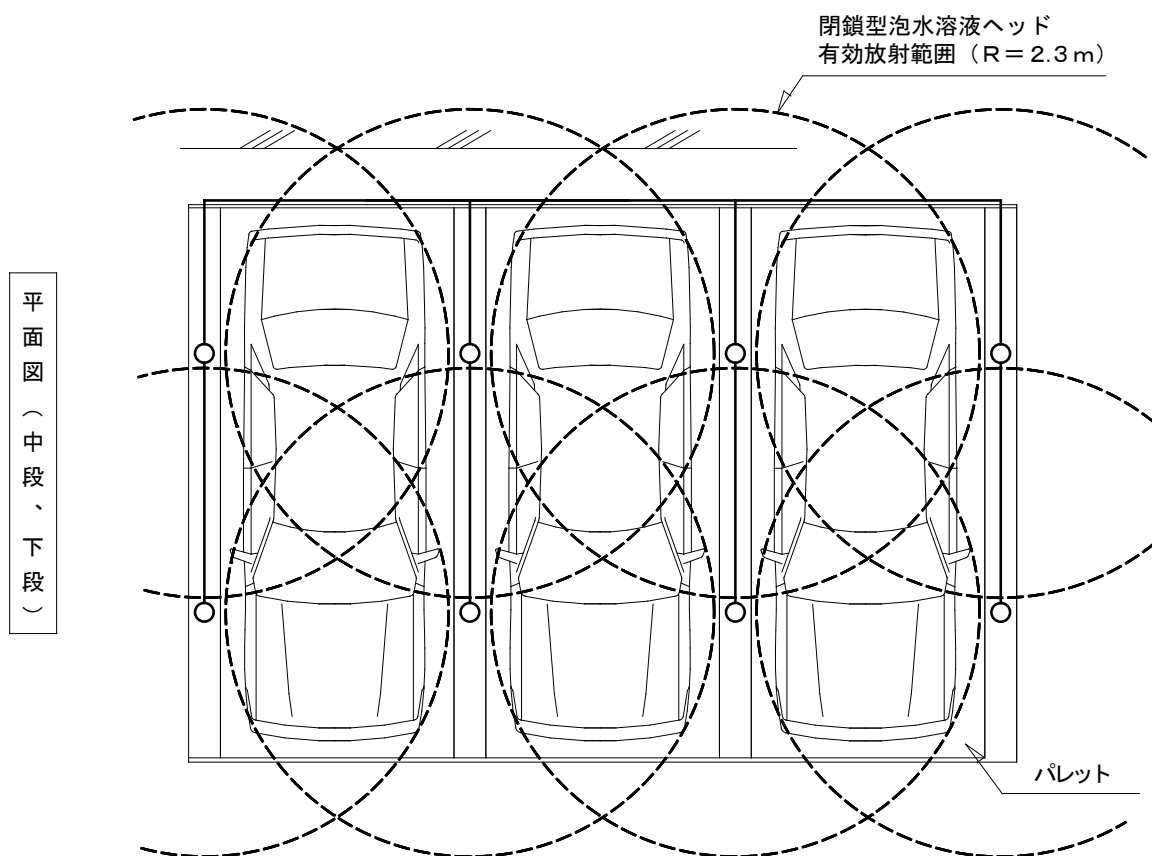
機械式駐車場設置例 (その 2)、平面図 (中段、下段)
